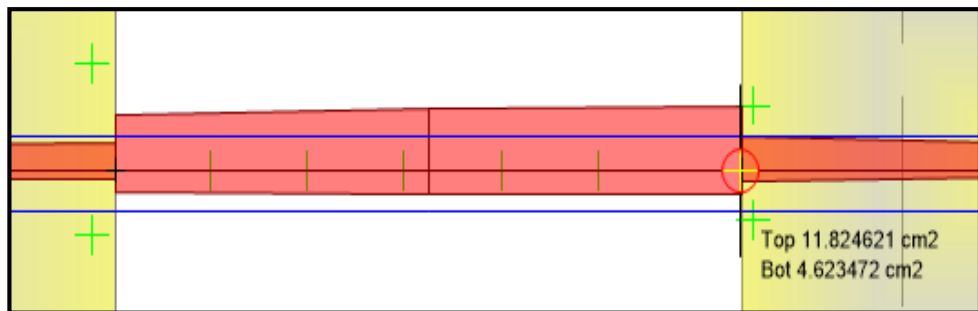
Detalle del acero en la viga de cimentación- Tramo de ejes 3 a eje 5.
